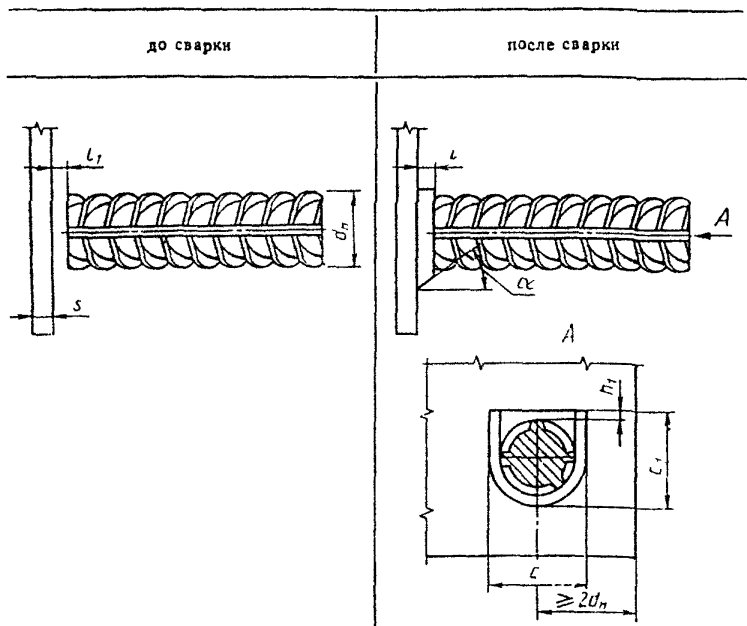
Конструкция таврового соединения, выполняемого ручной дуговой сваркой с использованием инвентарных формующих устройств
